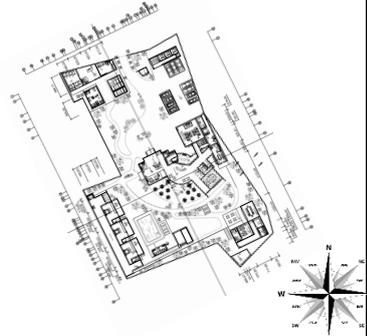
Denah Wellness Center Bumi Bandhawa
